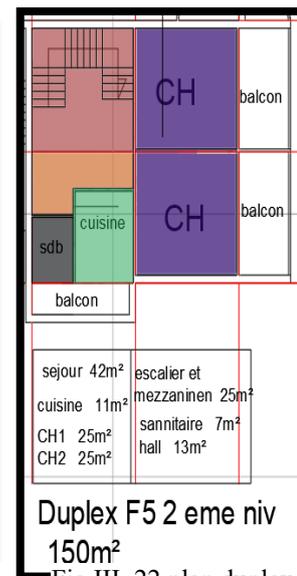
plan duplex F5 2eme niv (source :auteur)
